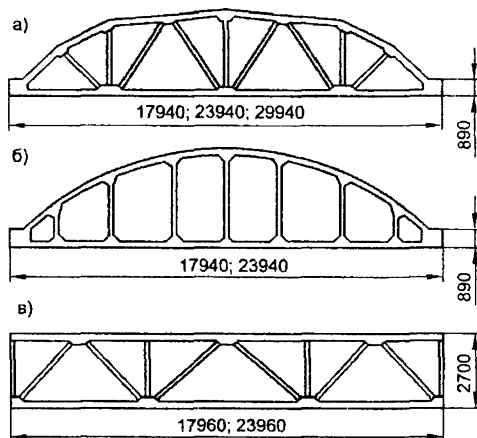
Железобетонные стропильные фермы: а – сегментные; б – арочные; в – с параллельными поясами
